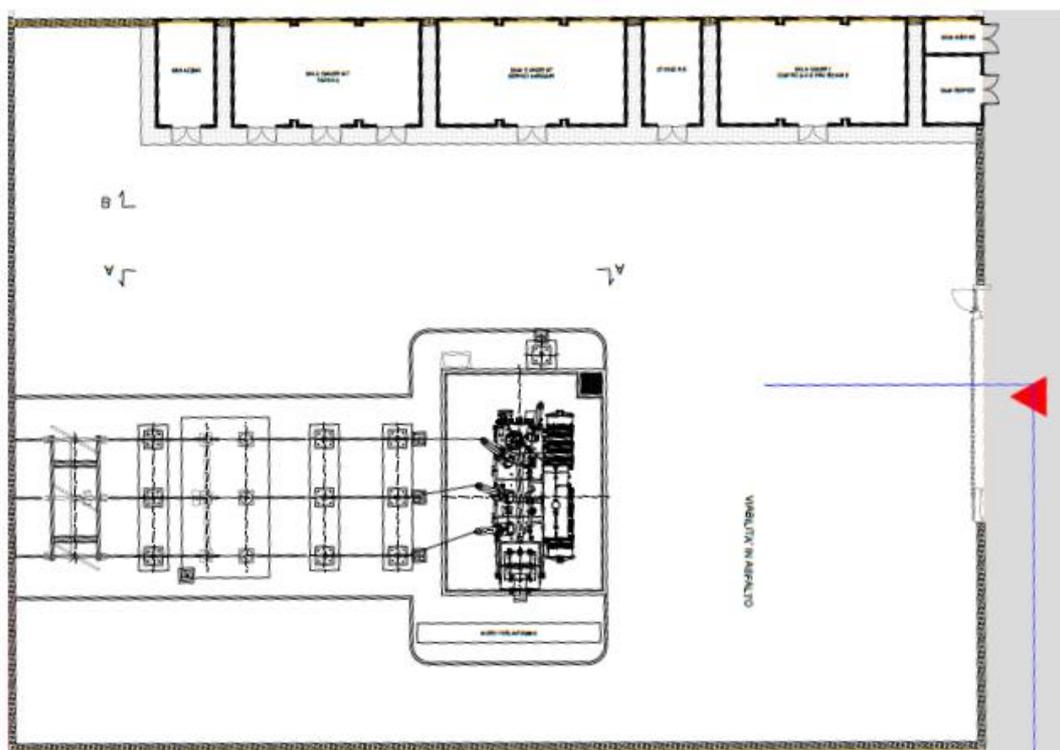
Planimetria della SSE utente di trasformazione 30/150 kV
